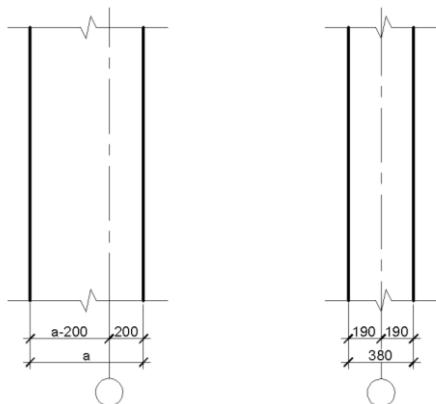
Привязка бескаркасных стен многоэтажных зданий
